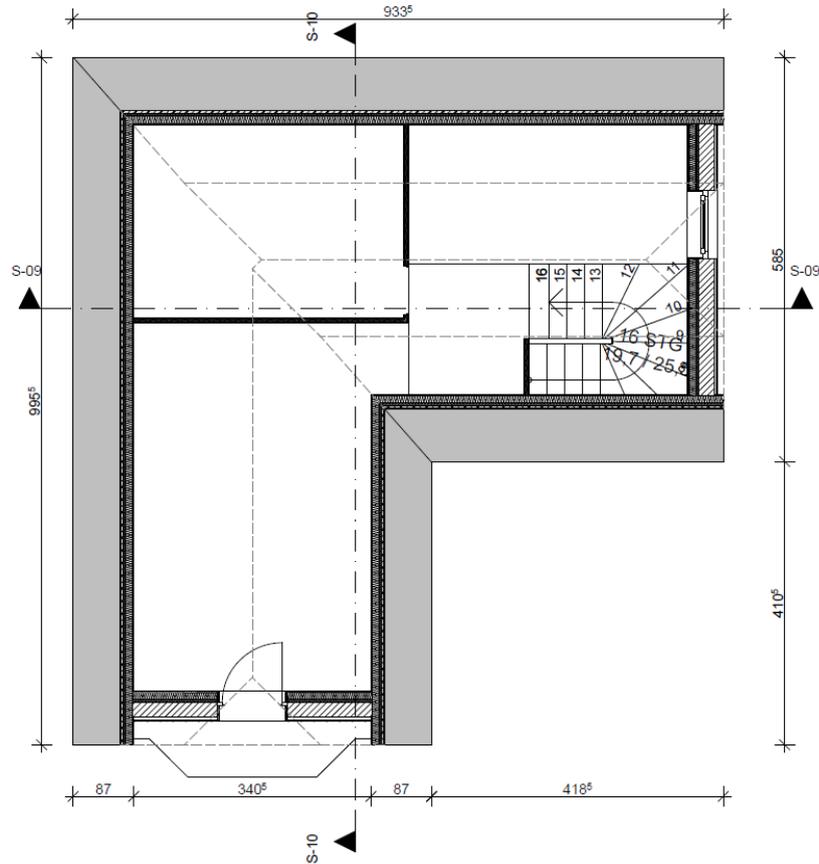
Fallbeispiel - Grundriss 1. Dachgeschoss, Software Archicad 26, (eigene Darstellung)
